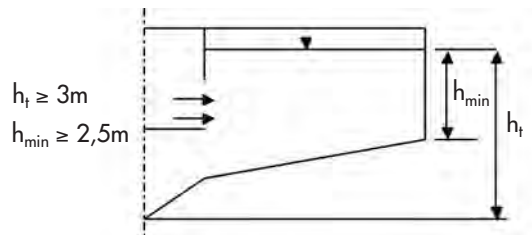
Sección de un decantador secundario estático de flujo horizontal con raquetas
